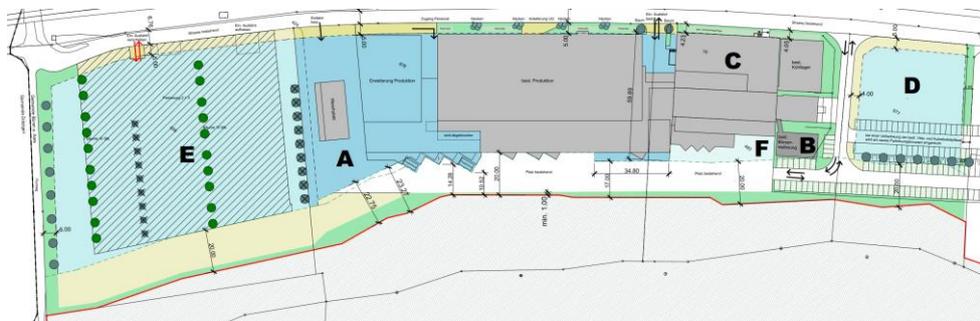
Ausschnitt bislang rechtsgültiger Überbauungsplan, erstellt 2004 mit Änderung bis 2016
